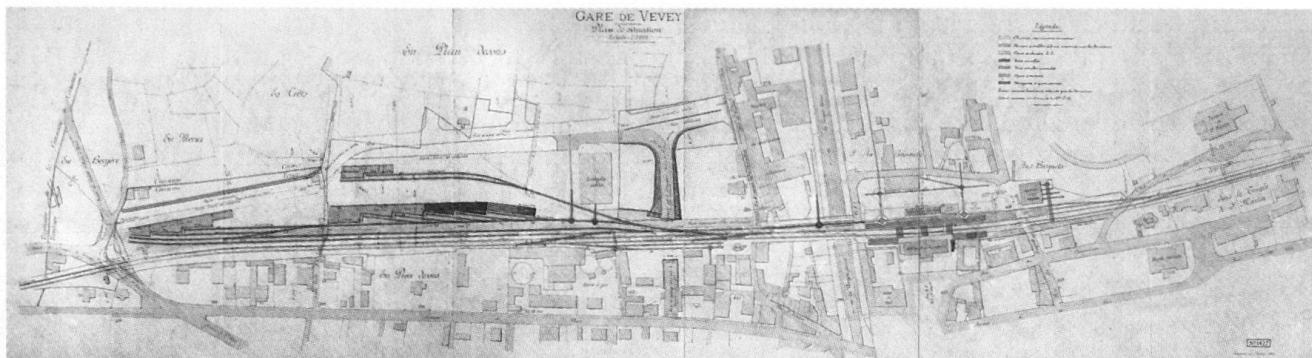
Gare de Vevey. Projet général d'aménagement avec installation de service de marchandises en Plan-Dessus. Plan de situation, dressé par l'ingénieur A. Gautschi le 18 mai 1899. Au centre, le nouveau passage en sous-voie de la route des Entrepôts.
